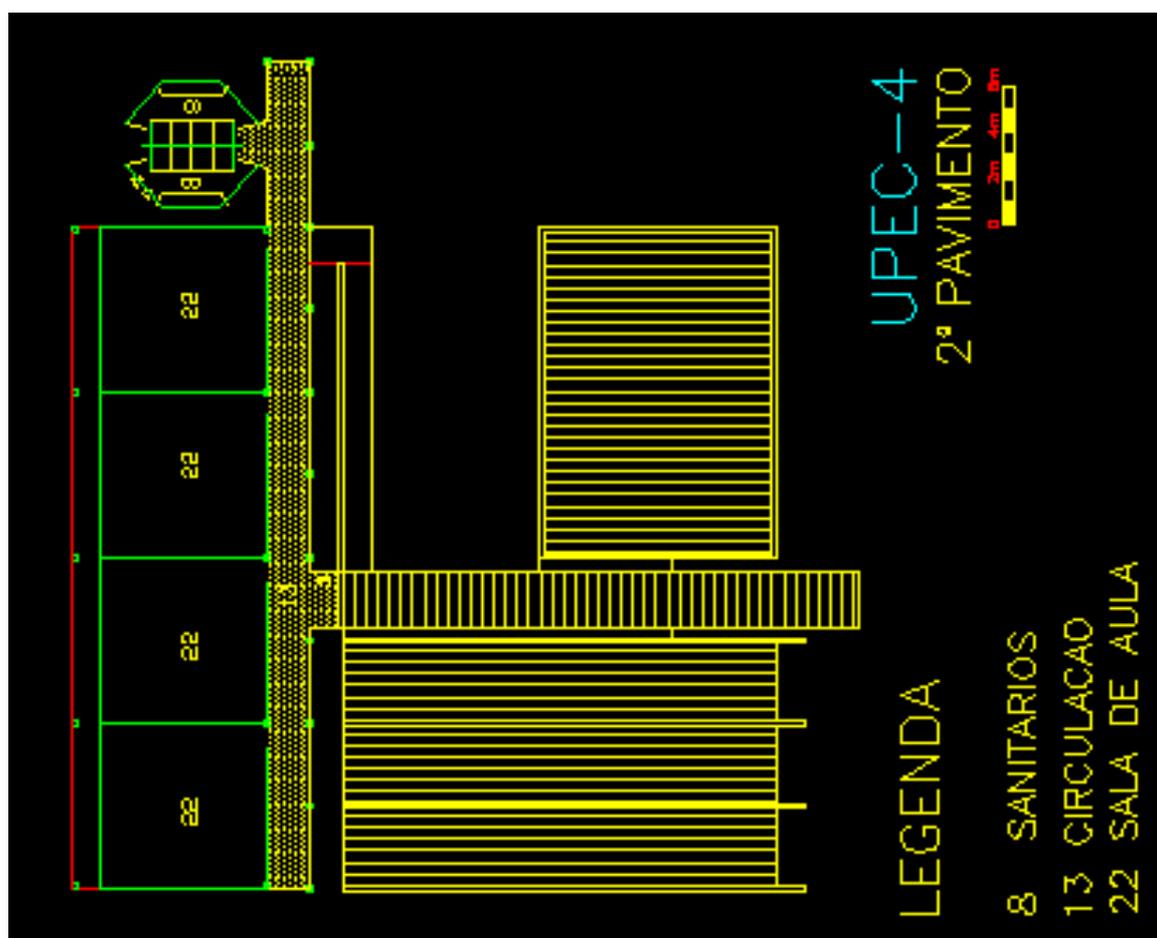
UPEC-4 / PLANTA 2º NÍVEL
